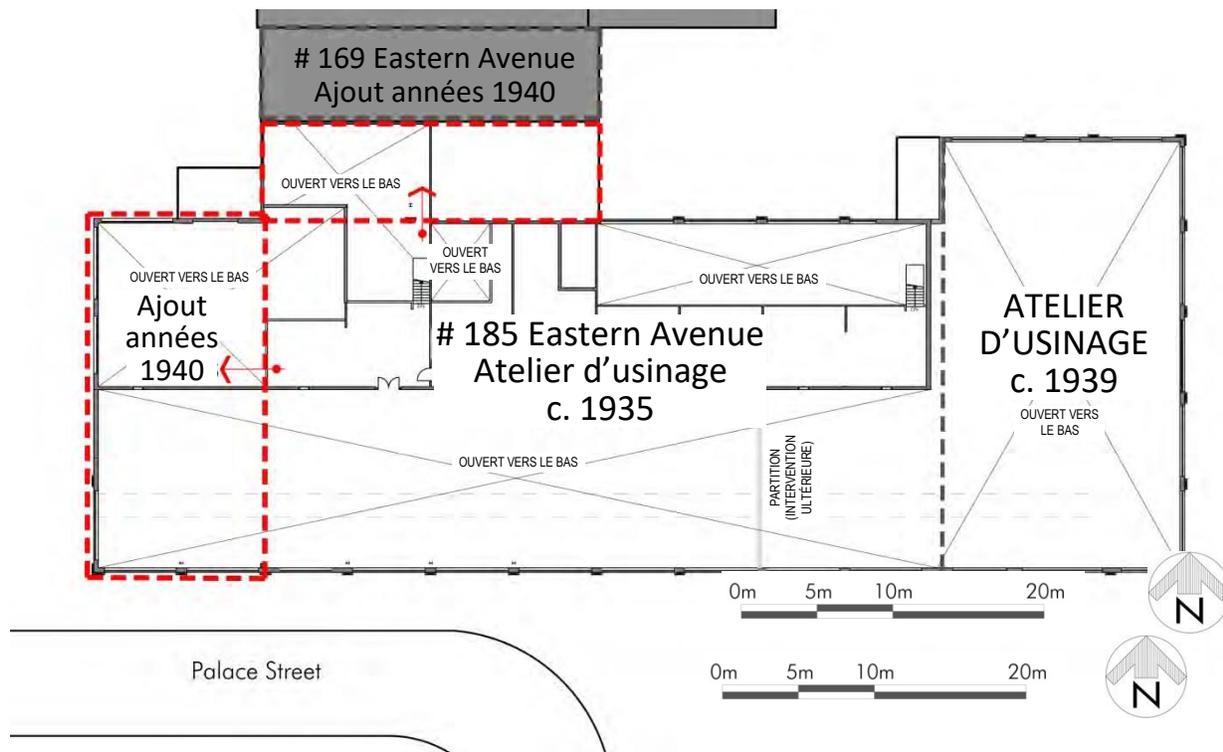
185 avenue Eastern – Atelier d’usinage – Plan de la mezzanine.
